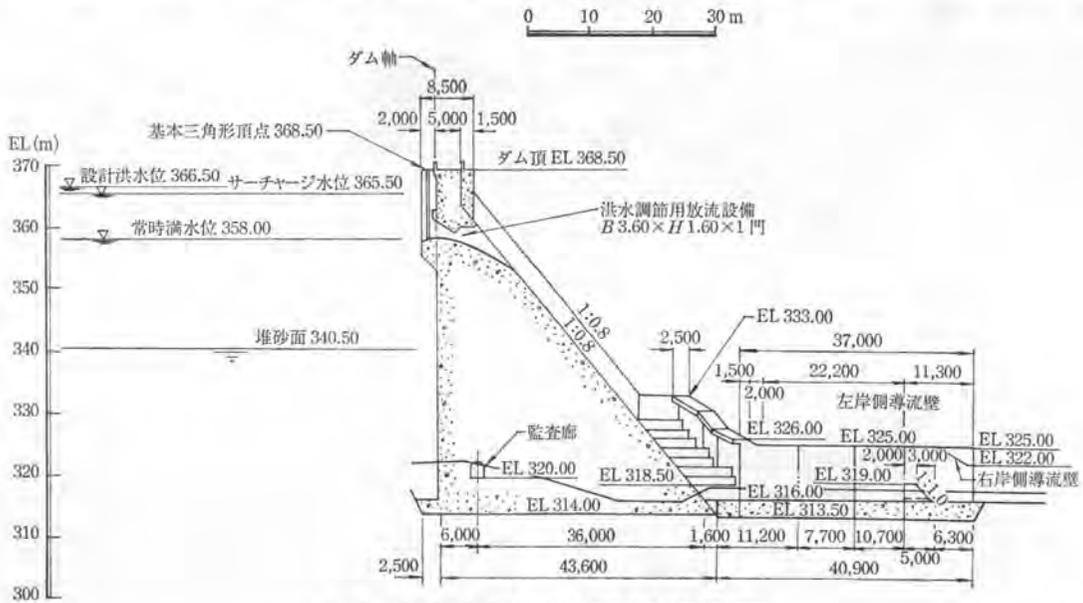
越流部標準断面図 (洪水調節用放流設備断面)
